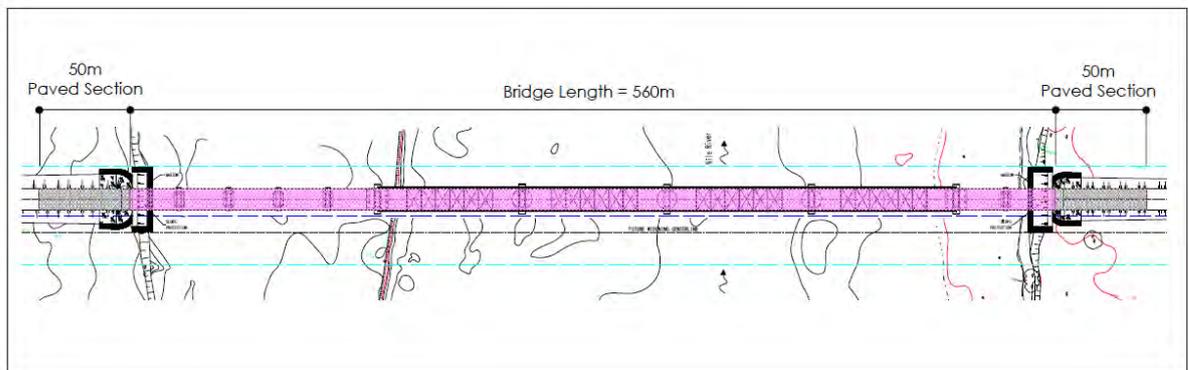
コンクリート舗装施工範囲(取付道路(1))
